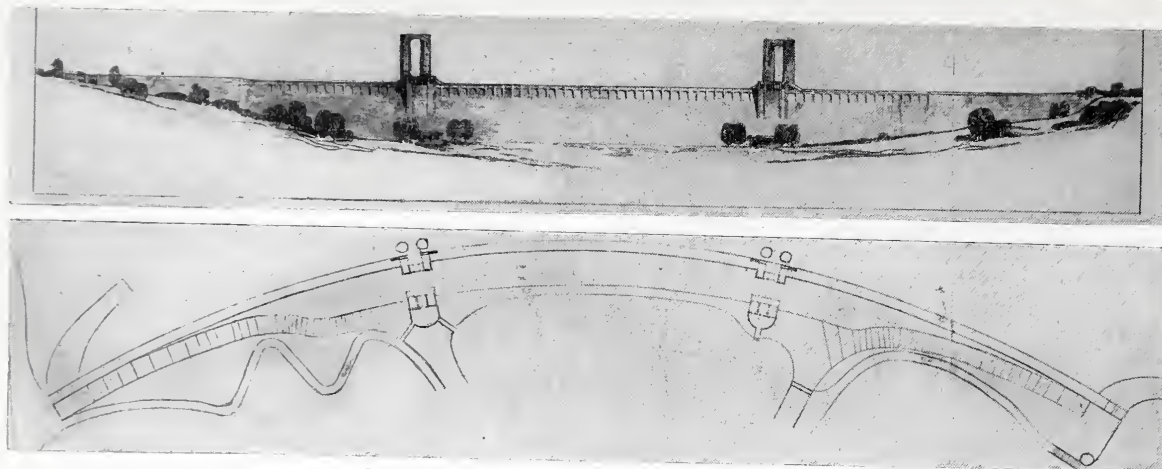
Ansicht und Grundriß der Sperrmauer.
